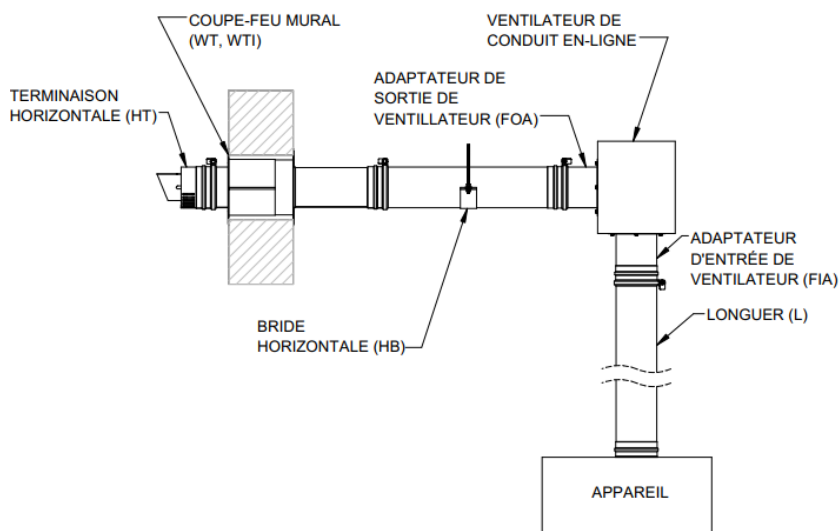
Installation horizontale avec ventilateur de conduit en-ligne
